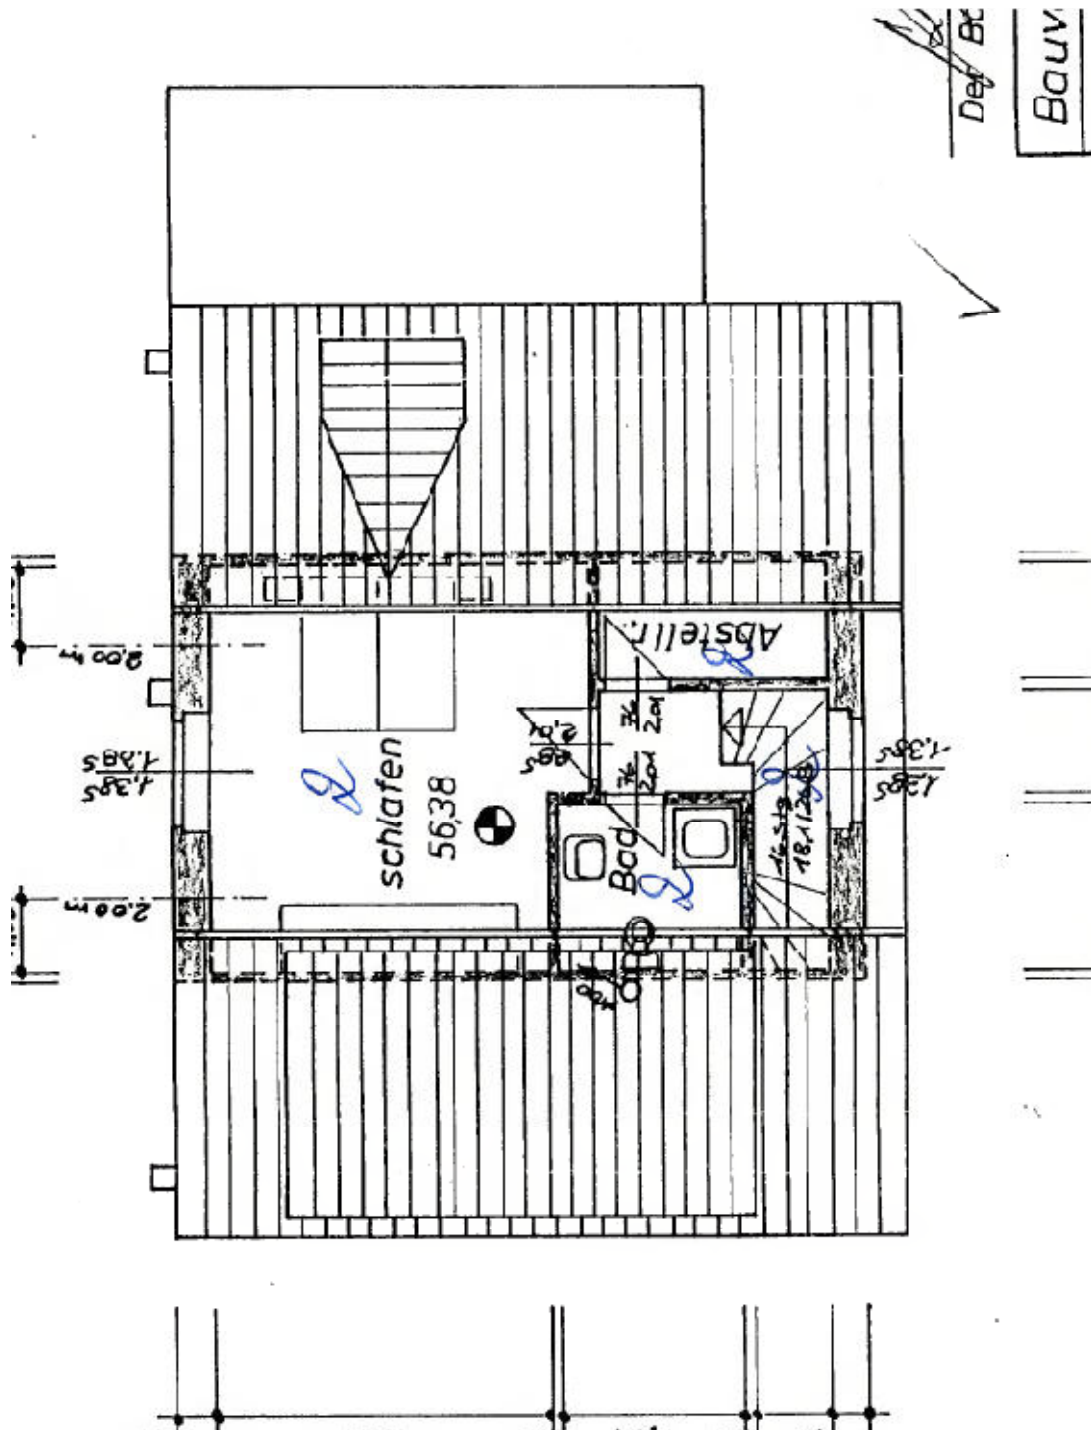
Dachgeschoss des Anbaues/ Plan aus der Bauakte Abweichungen sind möglich
